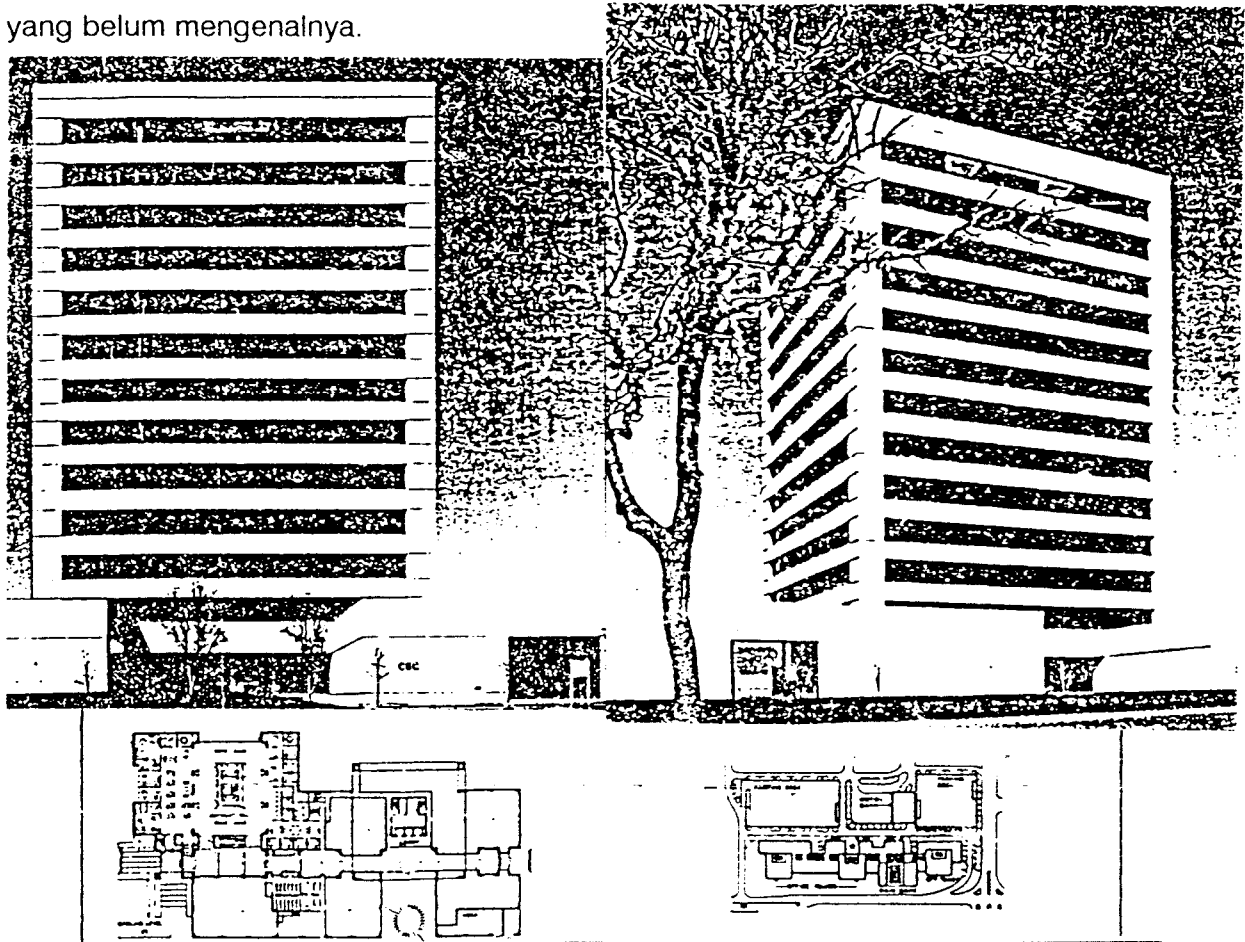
Manhattan's Bank of Tokyo, New York City.
